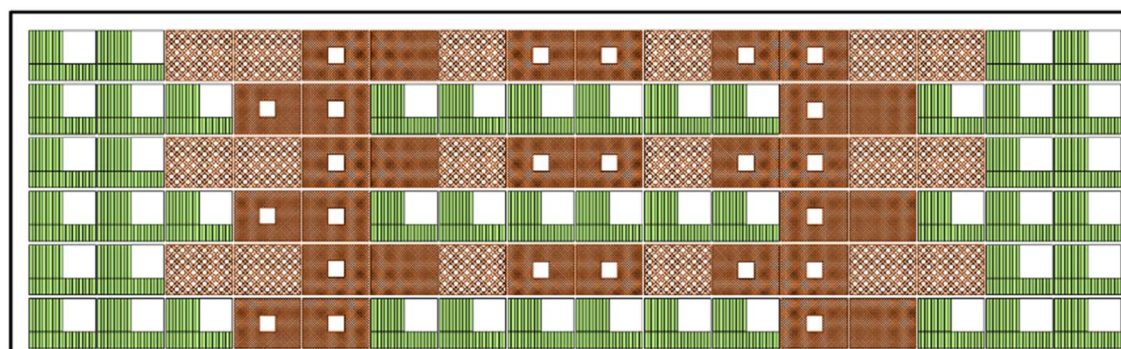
fachada proposta. fonte: acervo do grupo de pesquisa.
